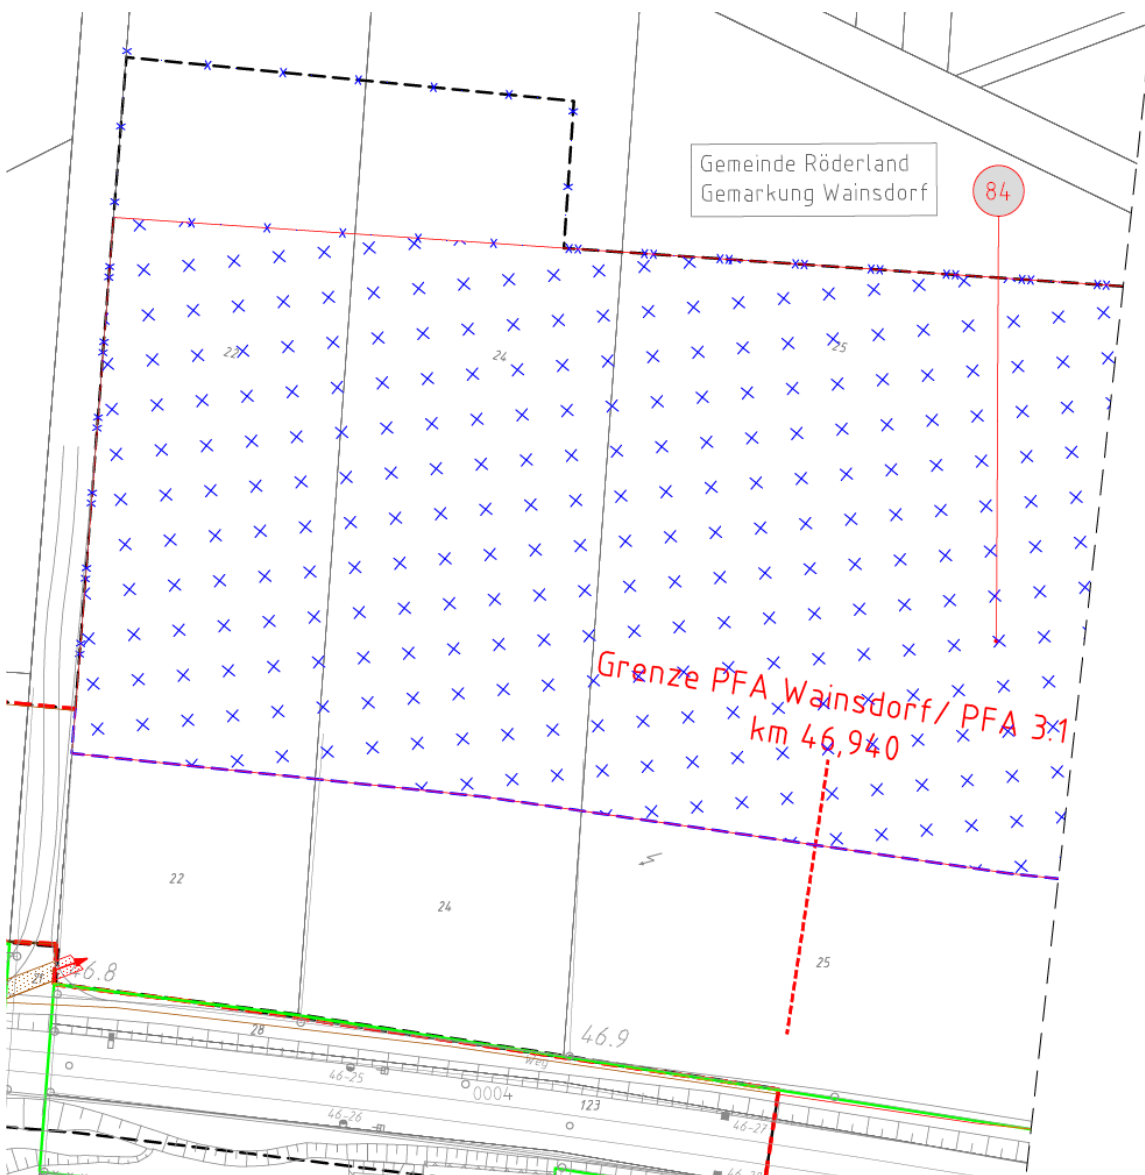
Auszug aus den Planfeststellungsunterlagen mit Stand 26.02.2025
